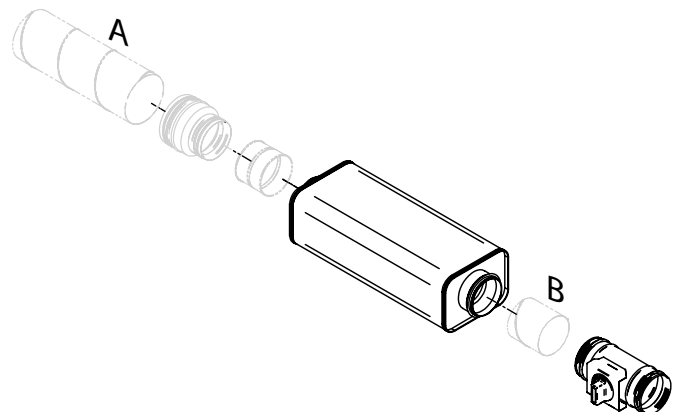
Kit d'air introduit, PARAGON T-SAK-CAV-100
